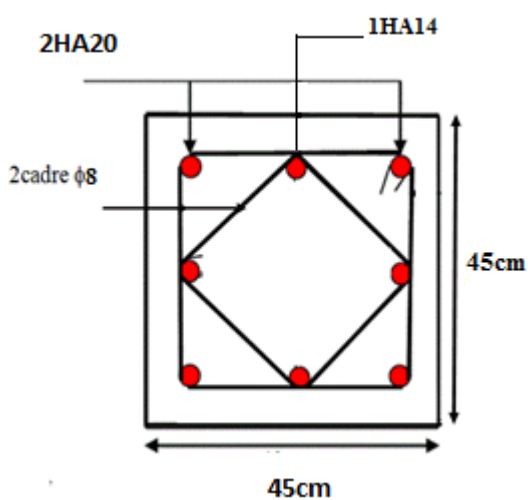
Schéma de ferrailage des poteaux 1^{er} et 2^{ème} étage.
